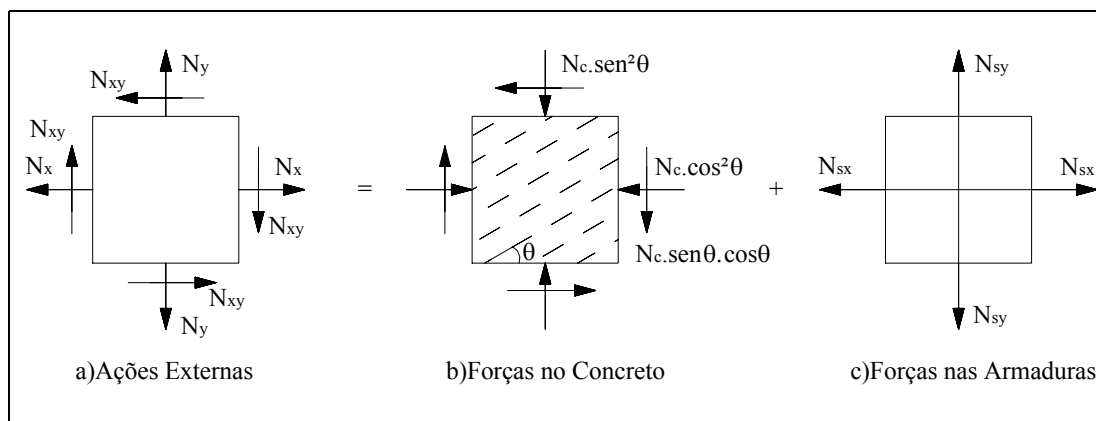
Elemento de concreto armado submetido a estado plano de tensões
